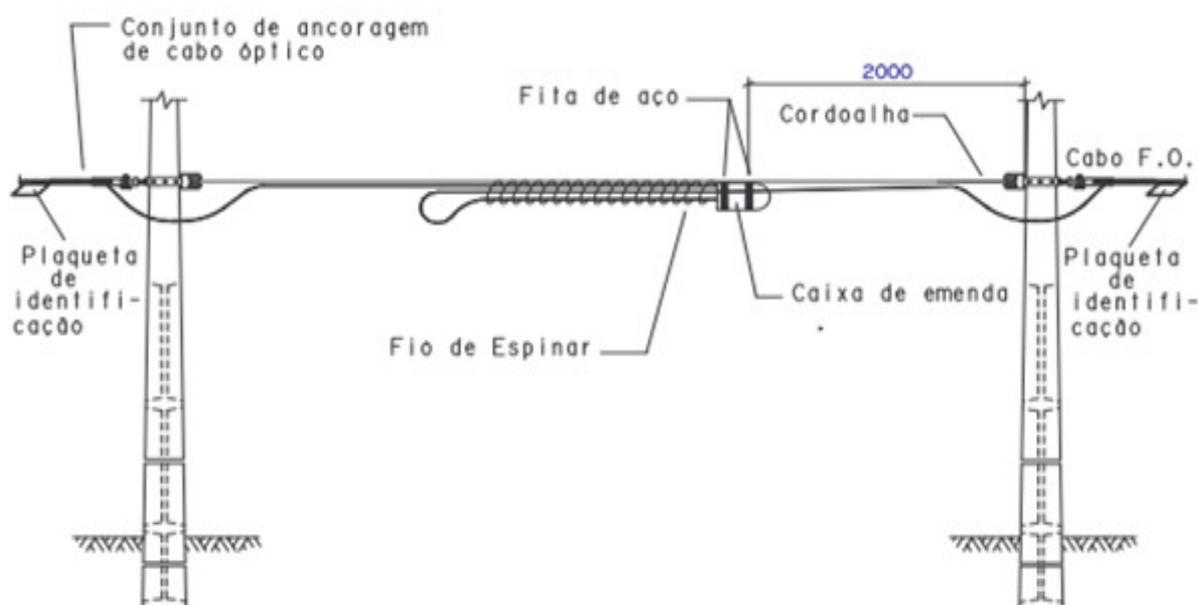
Instruções para caixa de emenda instalada no meio do vão.
